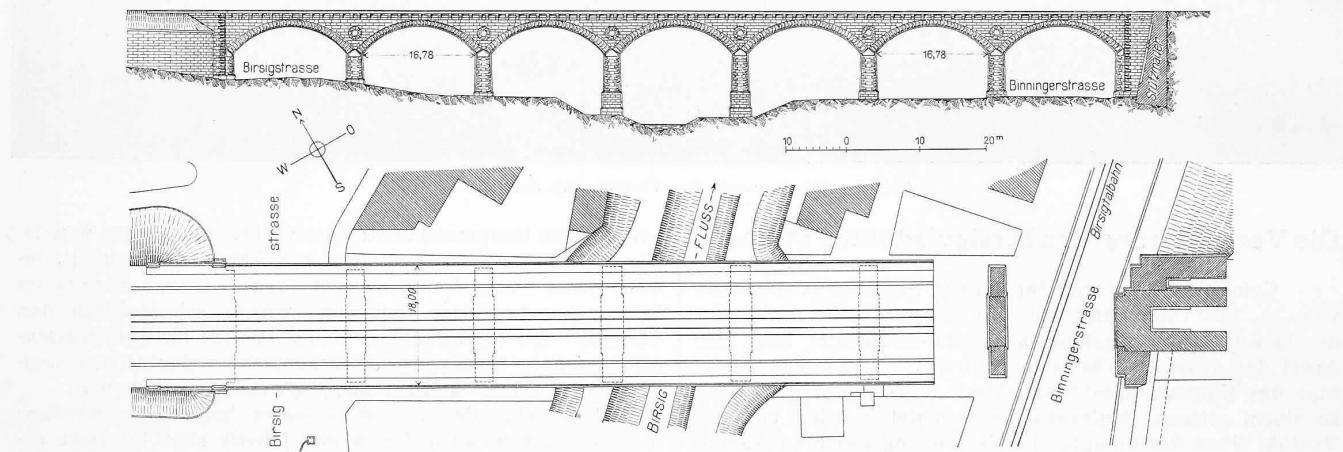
Aufriss und Grundriss des Ausführungsprojektes. — Masstab 1:1000.
